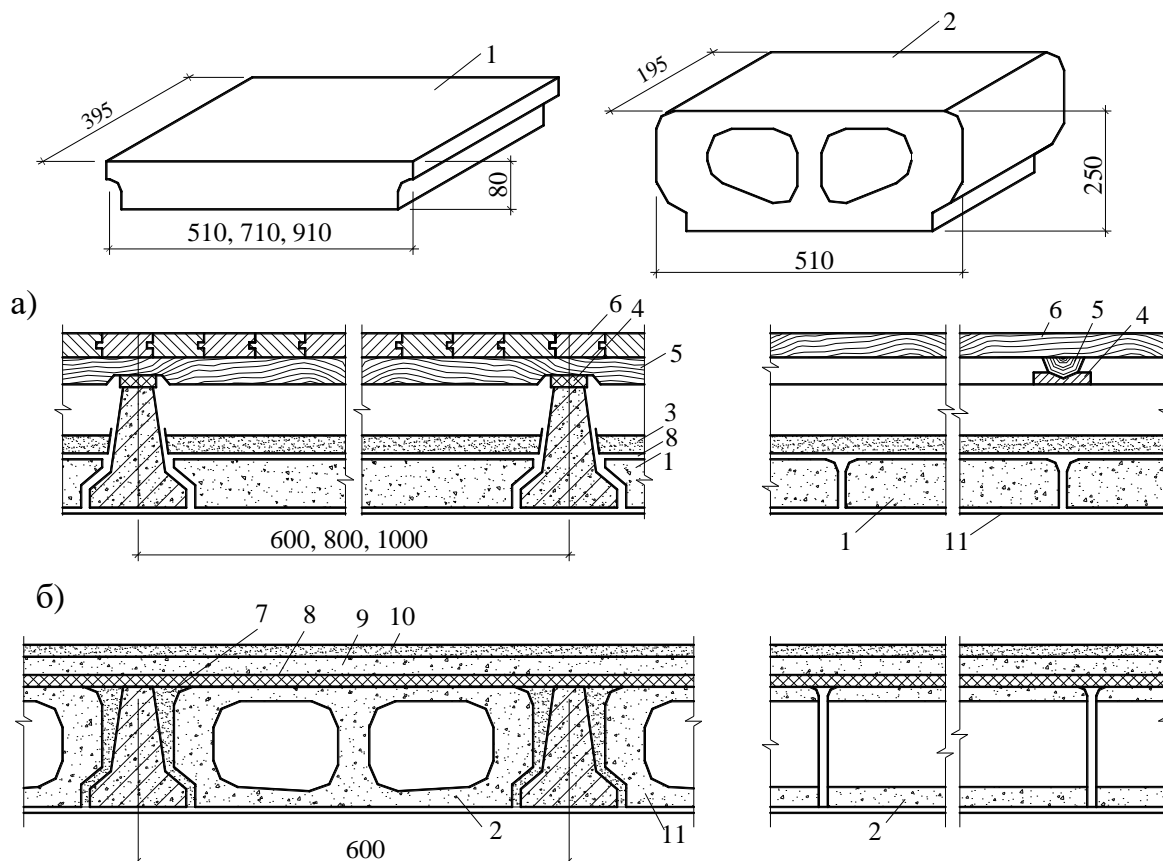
Міжповерхове переkritтя по залізобетонних балках:
